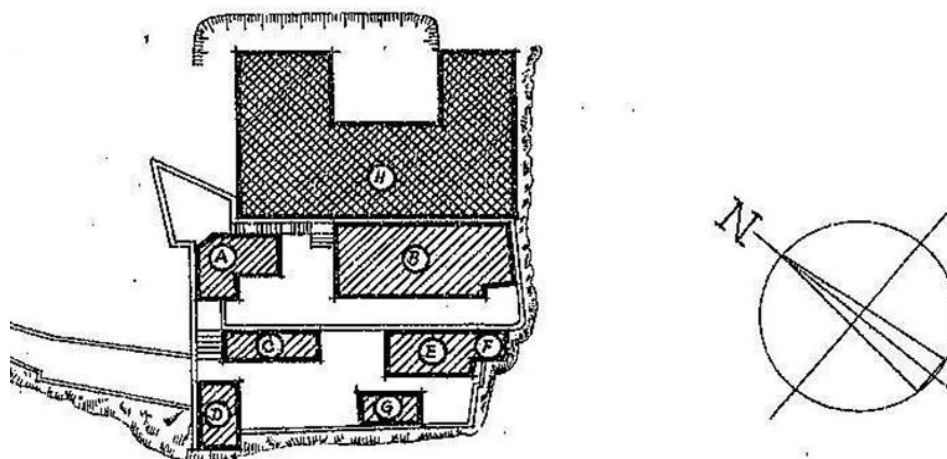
Planta Local do Forte S. João Baptista; A - Casa do Guarda; B - Dormitório; C - Despensa e arrecadação; D - Vestiário; E - Refeitório; F - Instalações sanitárias; G - Cozinha; H - Edifício a construir, (fonte: Instituto da Habitação e da Reabilitação Urbana (IHRU)).
